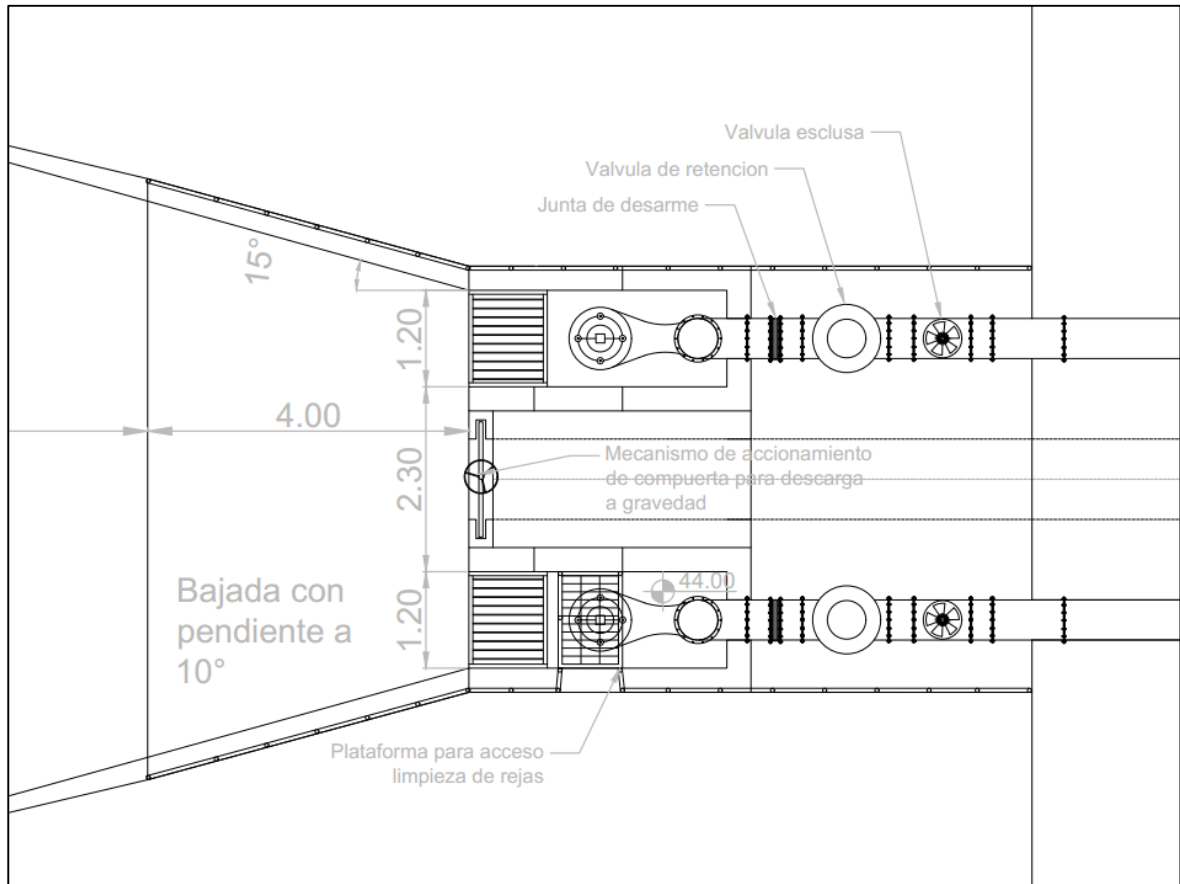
Planta cámara de aspiración. Fuente: Elaboración propia
